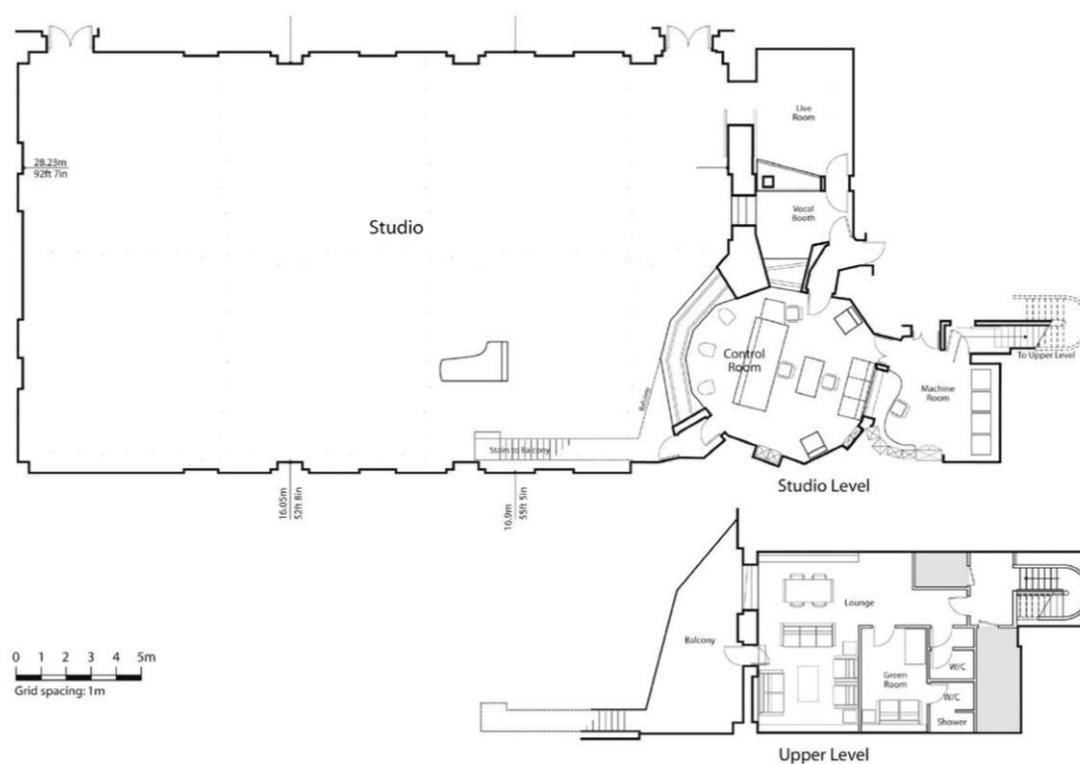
Plano de la planta de Estudio Uno de los estudios Abbey Road
